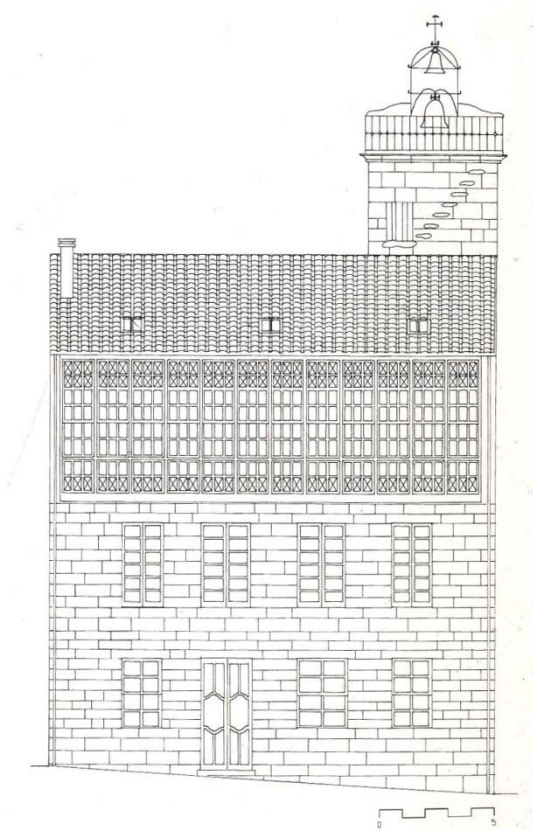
Alzado de la casa consistorial hacia la Rúa dos Ferreiros, construido siguiendo la tipología de fachada planteada en el proyecto de 1971, con galería en planta segunda.
